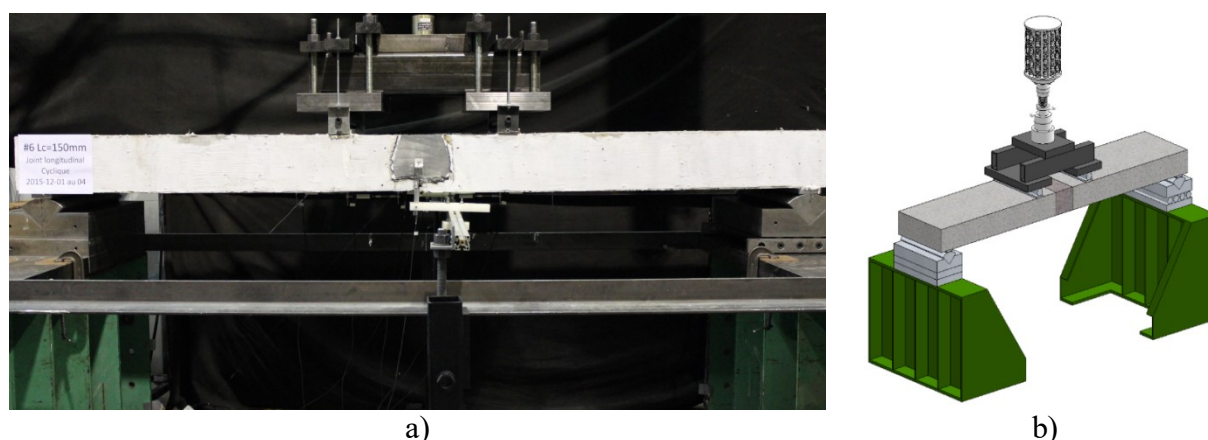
Montage en laboratoire – Dalle avec joint de connexion longitudinal, a) Photo en laboratoire, b) Vue schématique en 3D
